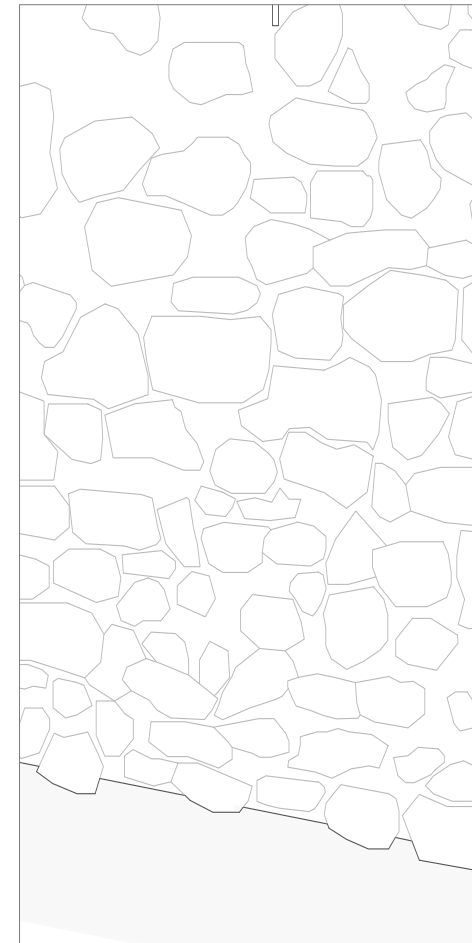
Detalle muro de mampostería en zona inferior de fachada Sur.
